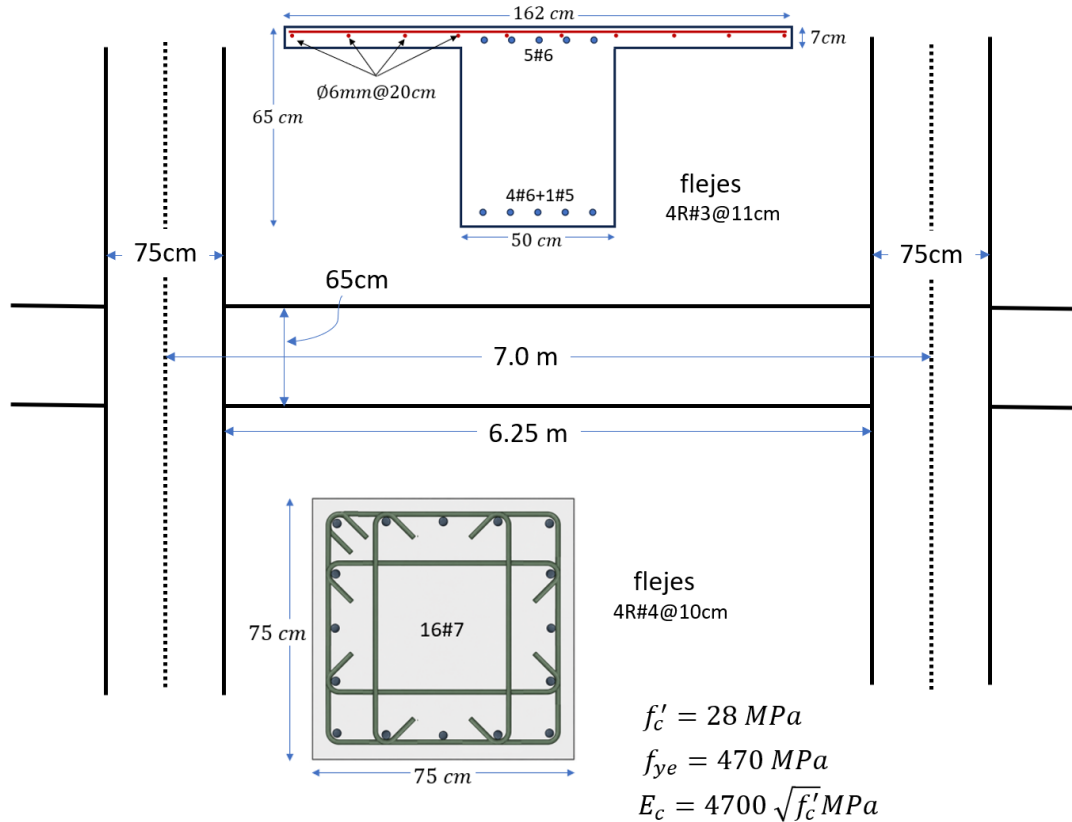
Tramo de pórtico mostrando configuración de la viga, las columnas y sus secciones transversales. Estas secciones y elementos estructurales serán la base para el desarrollo de algunos talleres.
